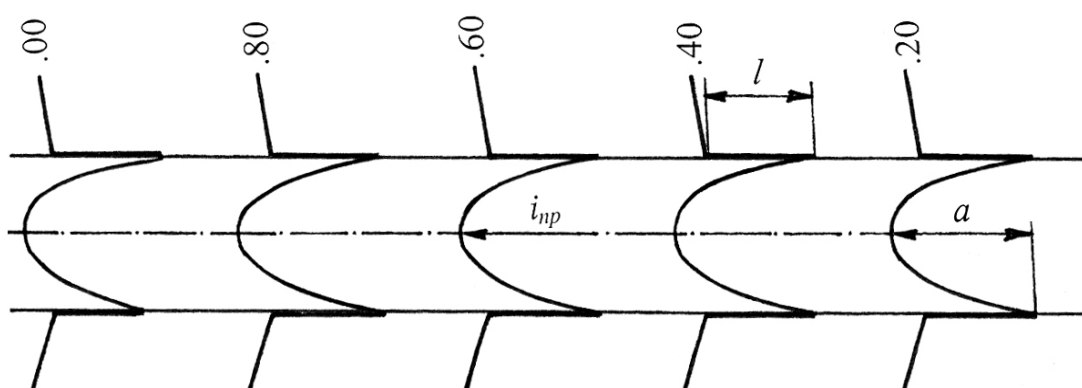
Схема вертикальной планировки садово-парковой дорожки с параболическим поперечным профилем
